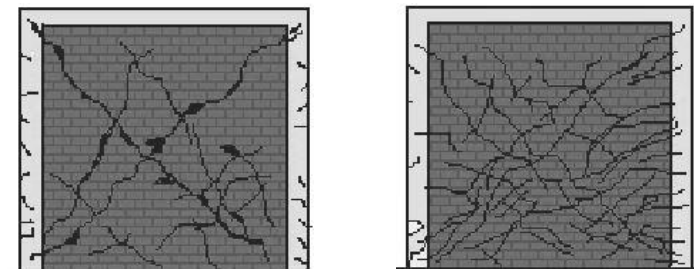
Falla de corte sin y con armadura horizontal en el paño
